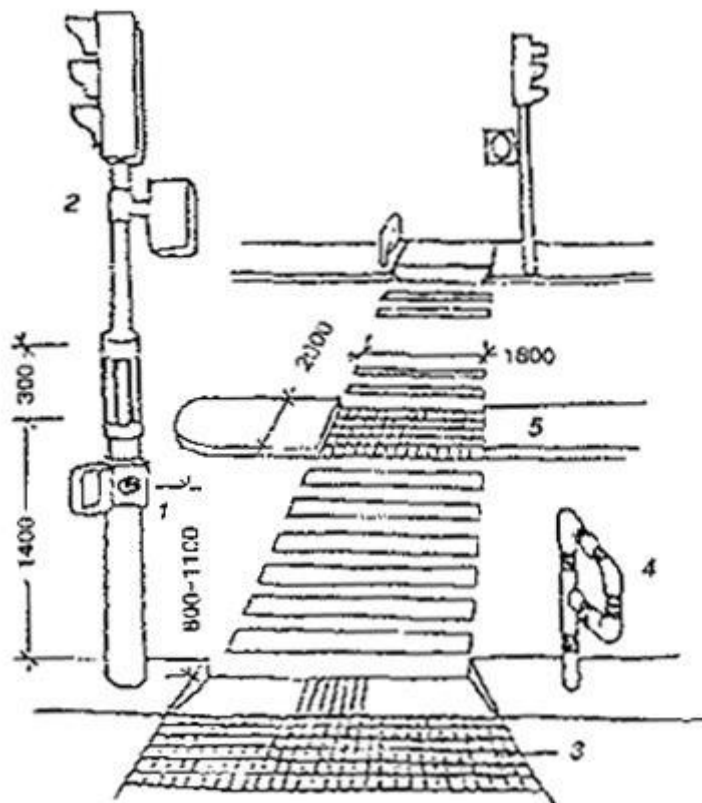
Наземный переход, оборудованный для использования инвалидами
